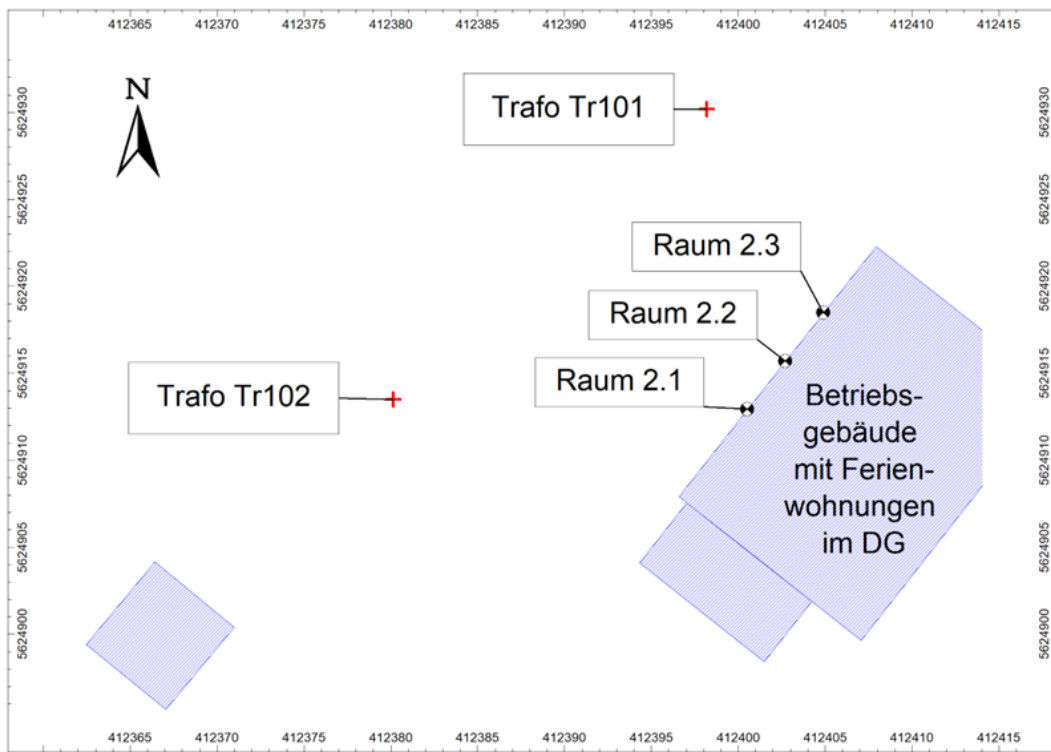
Lageplan mit Anlage 2 und Immissionsorten.
